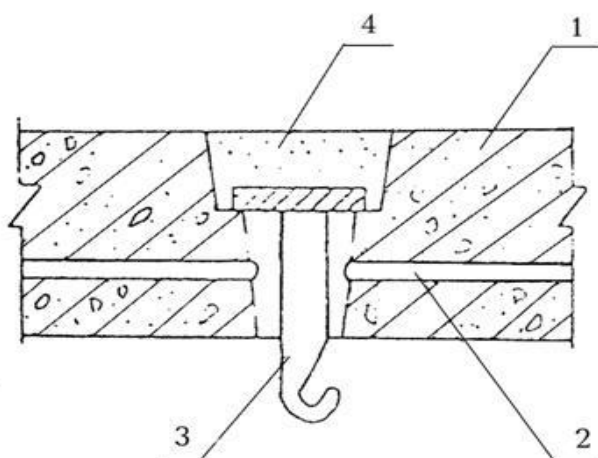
Схема конструктивного решения выпуска провода из перекрытия к поточному светильнику (перекрытие со сквозным отверстием): 1 – панель перекрытия; 2 – электроканал; 3 – крюк (приварен к круглой стальной пластине); 4 – раствор (заделка нижней части отверстия условно не показана).
